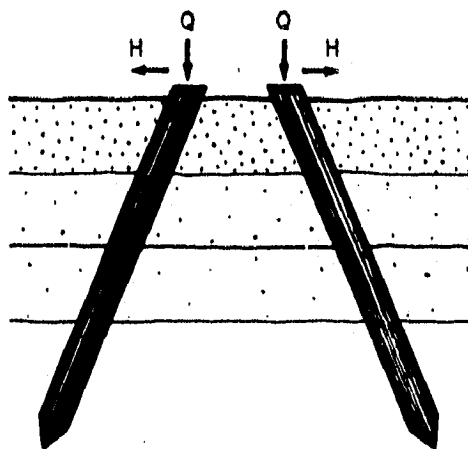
PILOTES INCLINADOS CON CARGA HORIZONTAL
